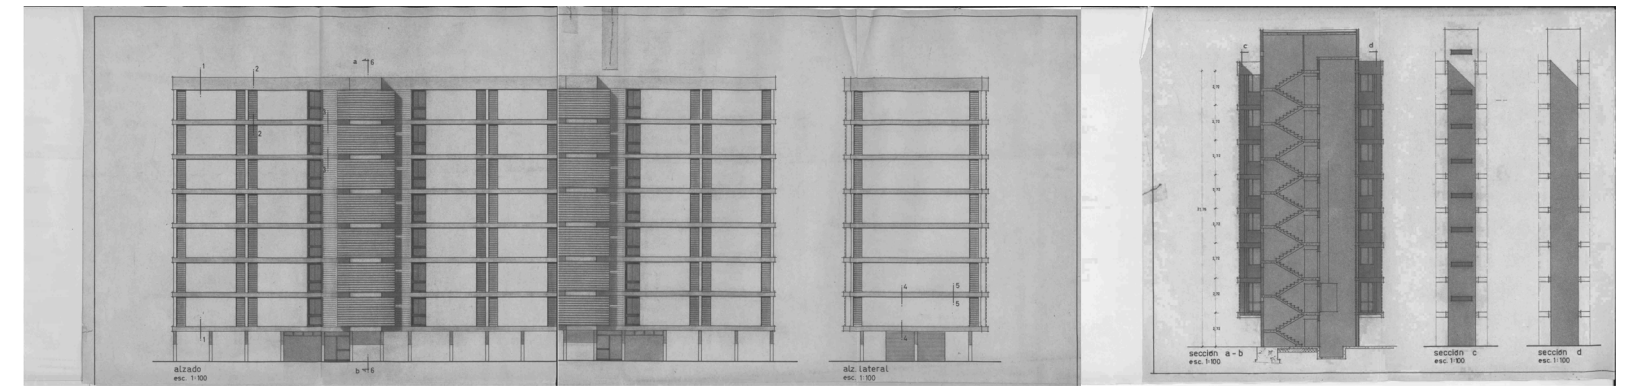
Plano alzados lateral y fronton de un bloque tipo.
